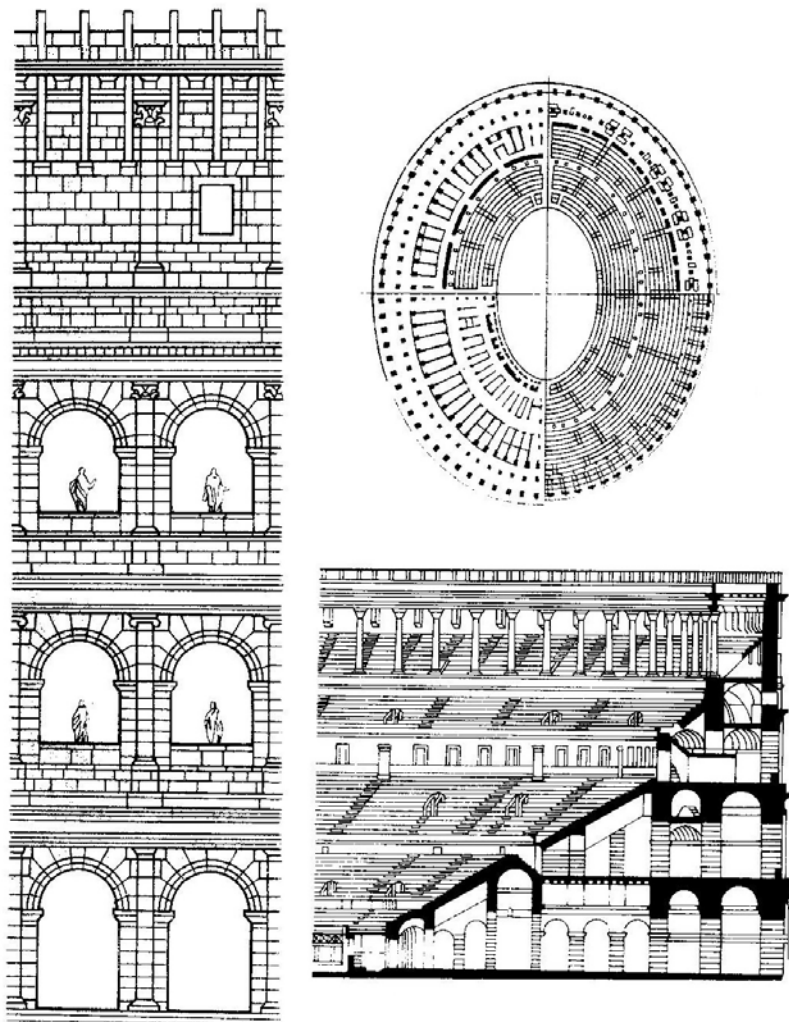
Колизей в Риме (69–96 гг. н. э.), фрагмент фасада, план, разрез
